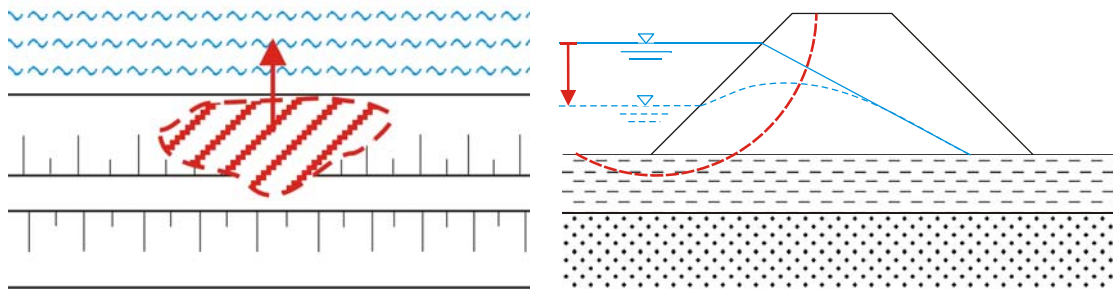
Hydraulisches Versagen einer Außenböschung (links: Draufsicht, rechts: Schnitt)
